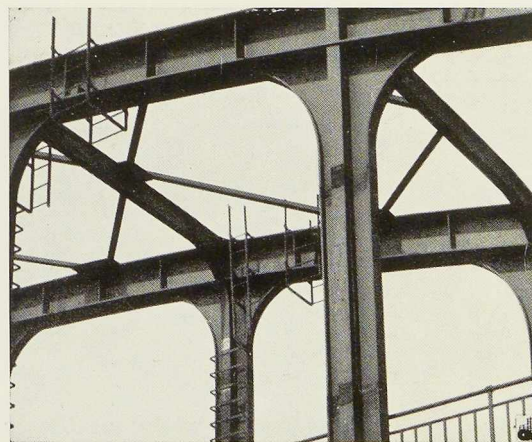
Détail du contreventement supérieur d'un montant. Le contreventement supérieur comporte des crois de Saint-André. Les montants ne sont pas constitués, comme dans de nombreux ponts, par deux poutrelles à larges ailes ; dans le plan de la poutre le double té est composé de tôles soudées.
